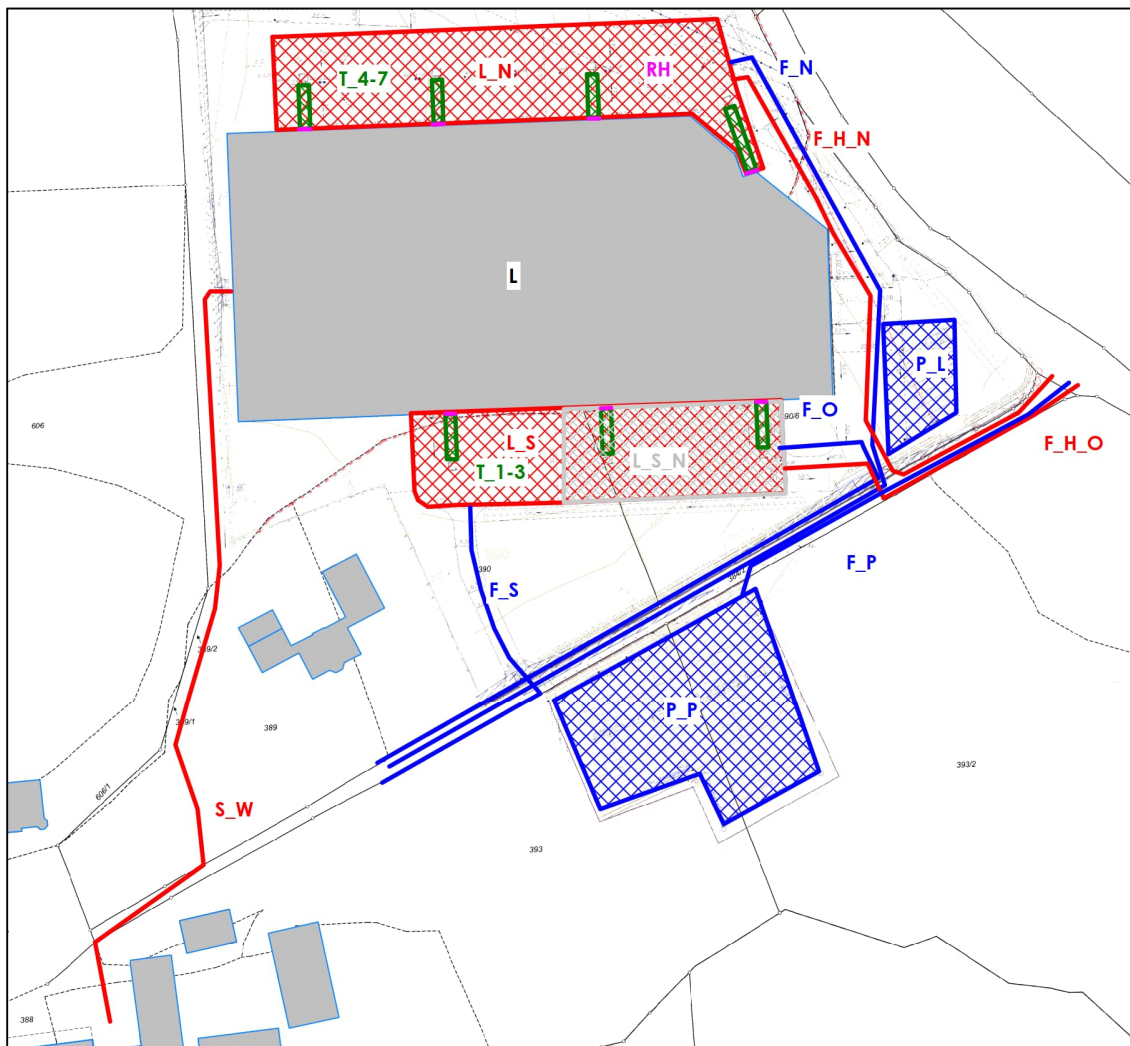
Lageplan mit Darstellung der relevanten Schallquellen
